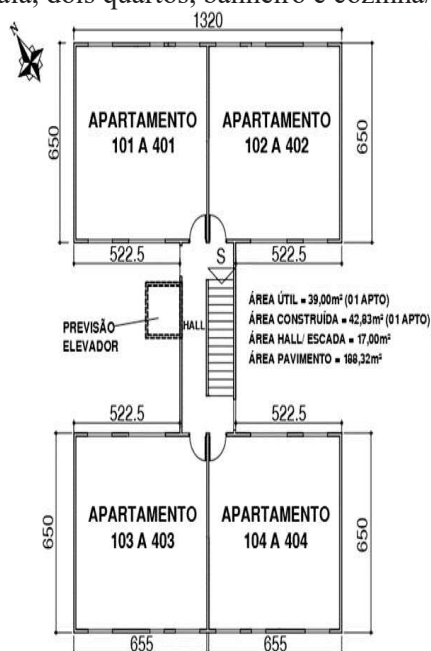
Planta de Pavimento Tipo do 1º ao 4º dos Blocos Tipo
